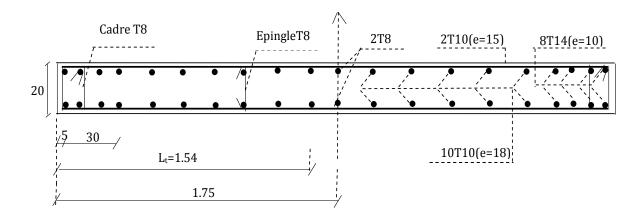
Schéma de ferraillage du voile (A et B) au RDC, 1et 2^{eme} étage
